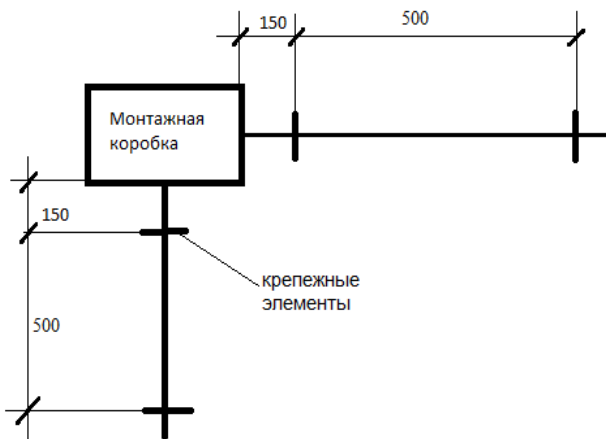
Схема крепления гофрированного металлорукава к несущей конструкции.
